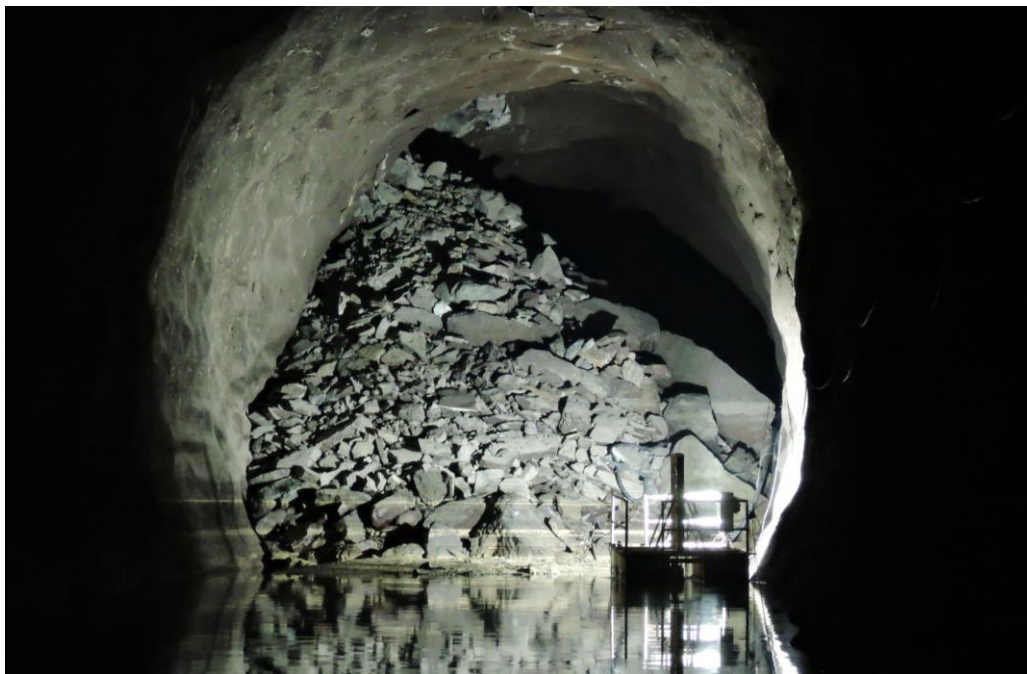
Obtížně přístupný povrch nad závalem 1 pro provádění vrtů a následnou betonáž
